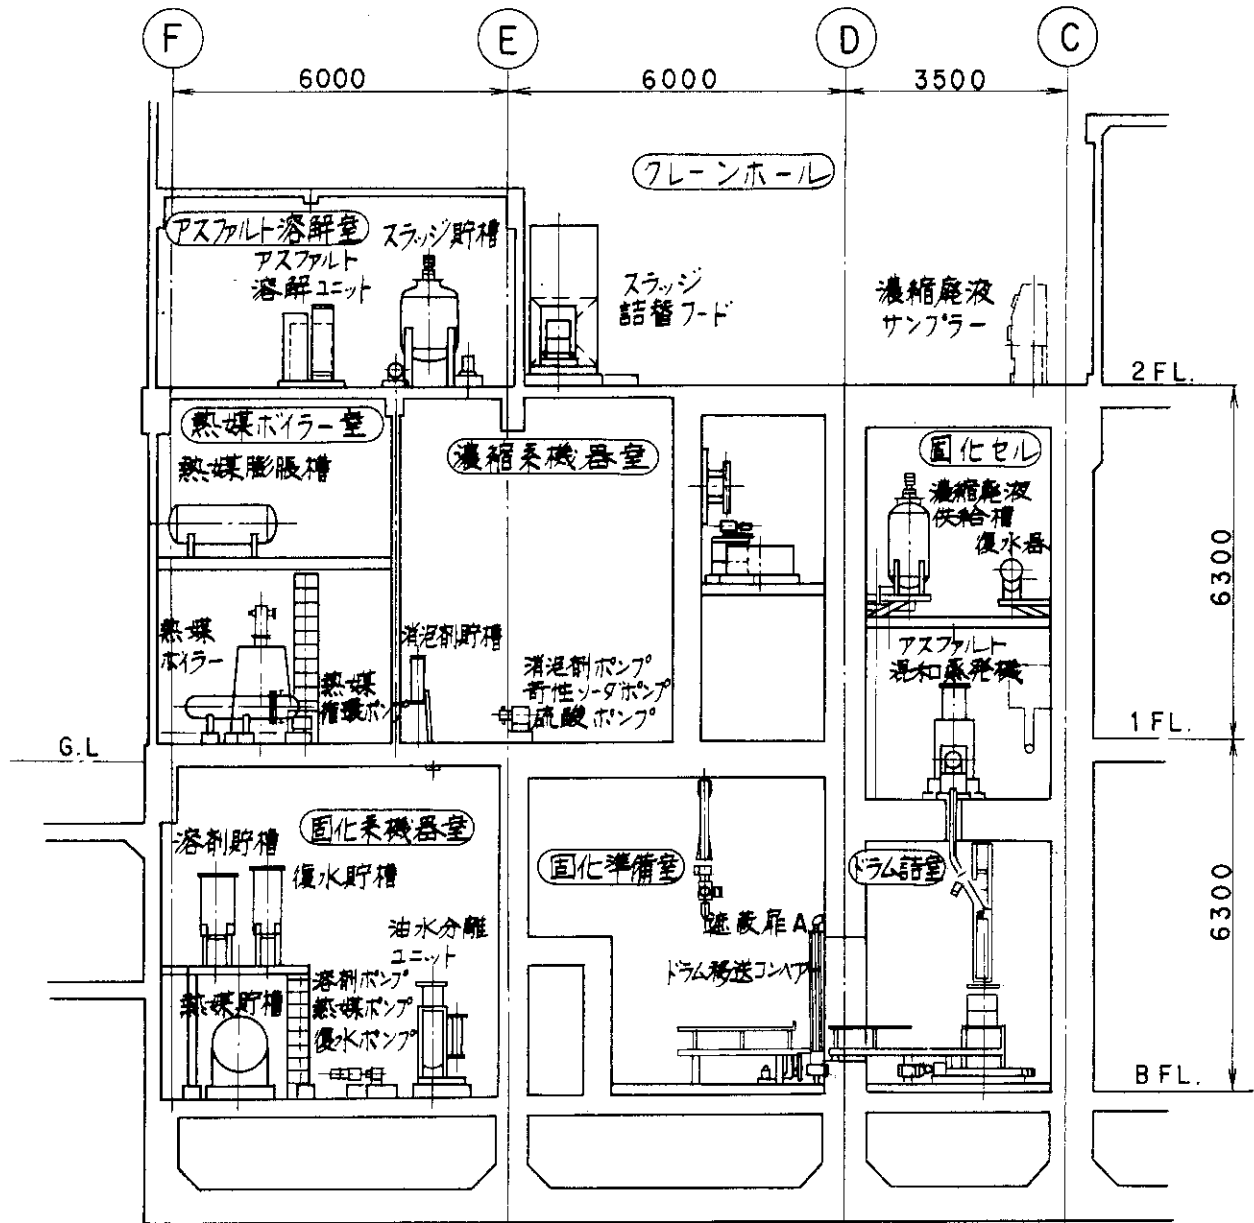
アスファルト固化処理設備機器配置図 (その4) 断面図
